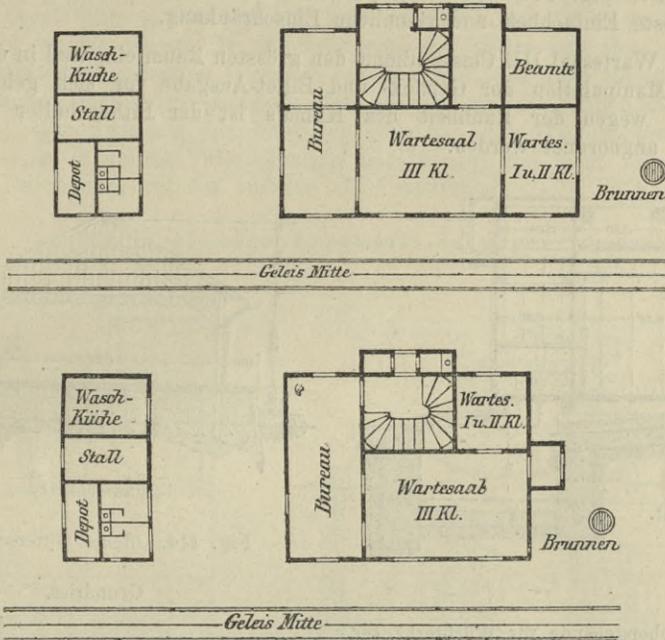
Aufnahmsgebäude I. Classe. Grundriss.
